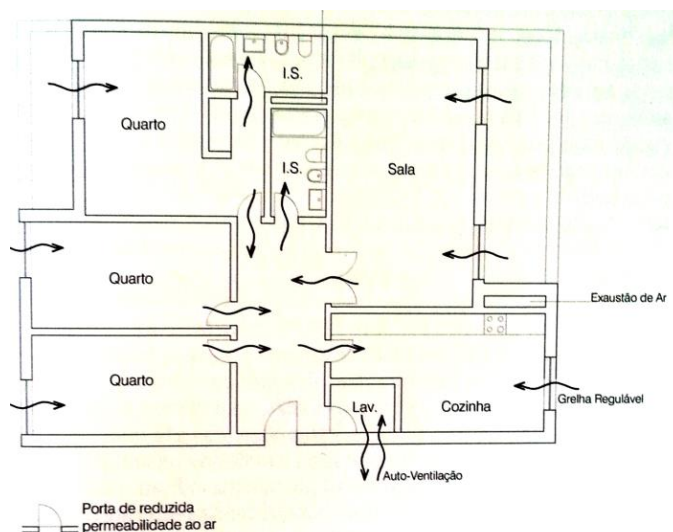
Exemplo esquemático de ventilação conjunta [34]
